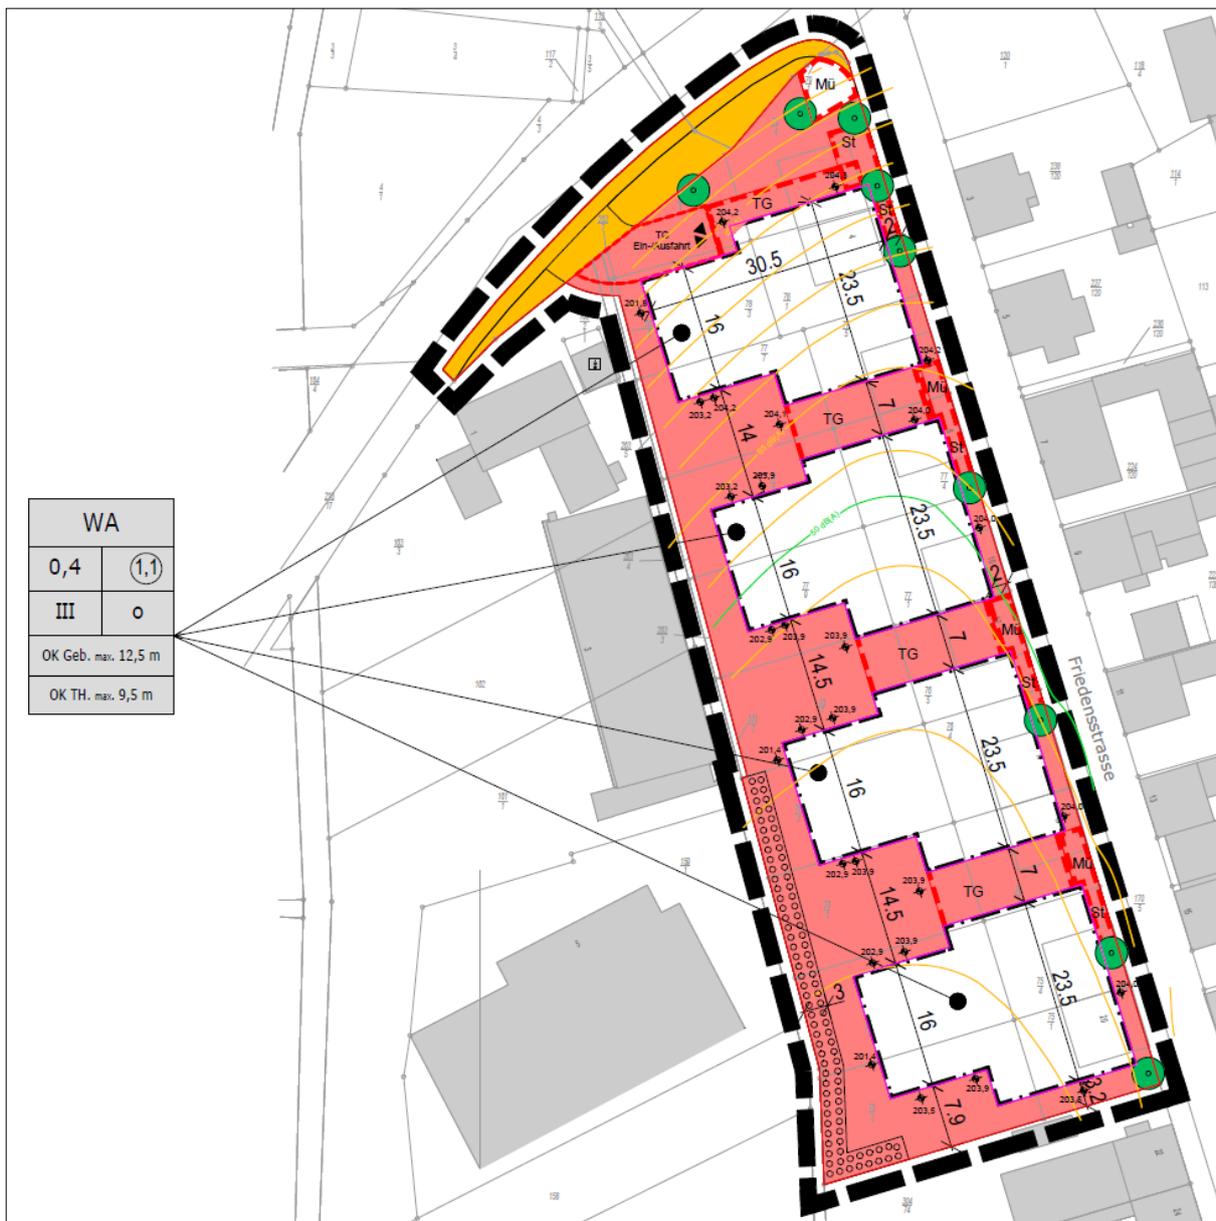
Ausschnitt aus dem Bebauungsplan "Friedensstraße", 1. Änderung (Stand 20.08.2020, Plan|ES)
